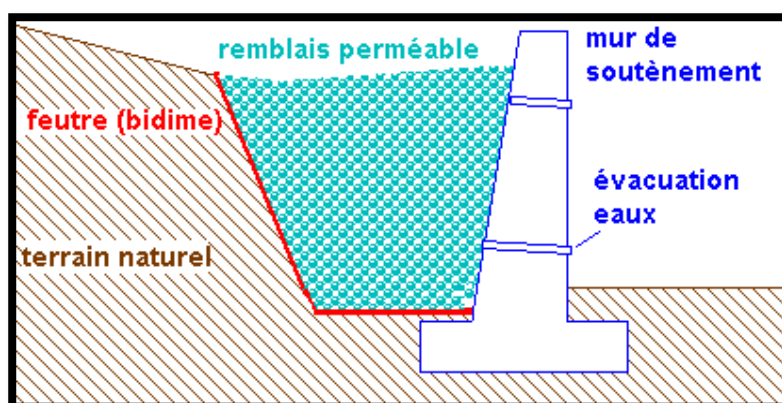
Détail d'un voile en béton armé . Source : <http://www.ideesmaison.com/Construction/Gros-travaux/Pose-d-un-mur-de-parpaings/Le-mur-de-soutènement.html>
